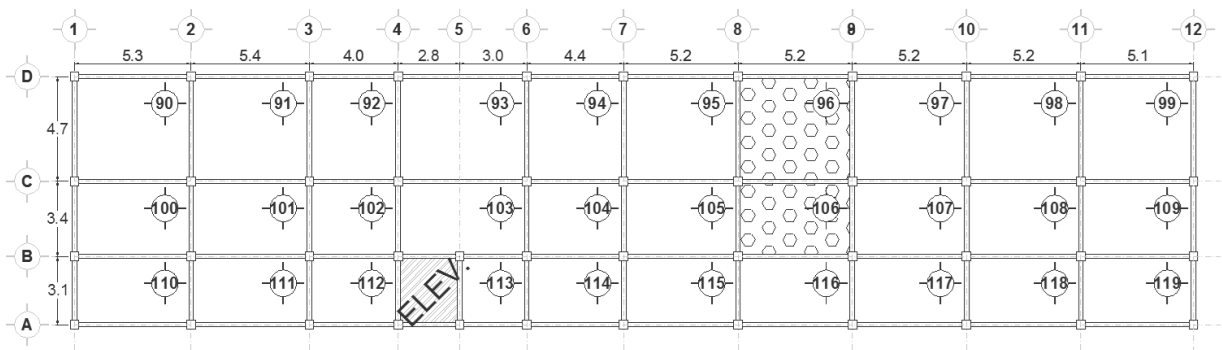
Vista en planta de losas de cuarto nivel.
